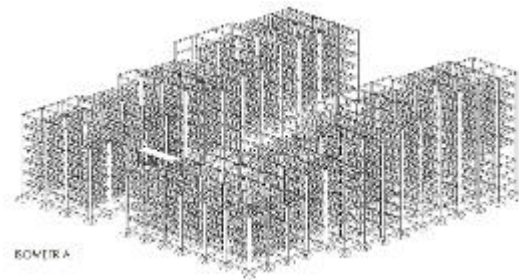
Esquema estructural (Scacco, S. 2024)
